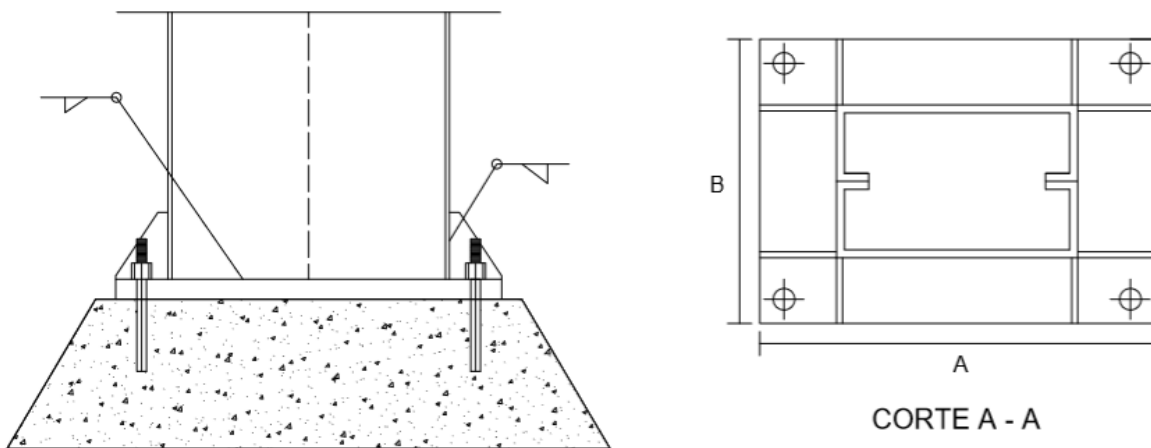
Placa de base do pilar (De PAULA, 2016)
